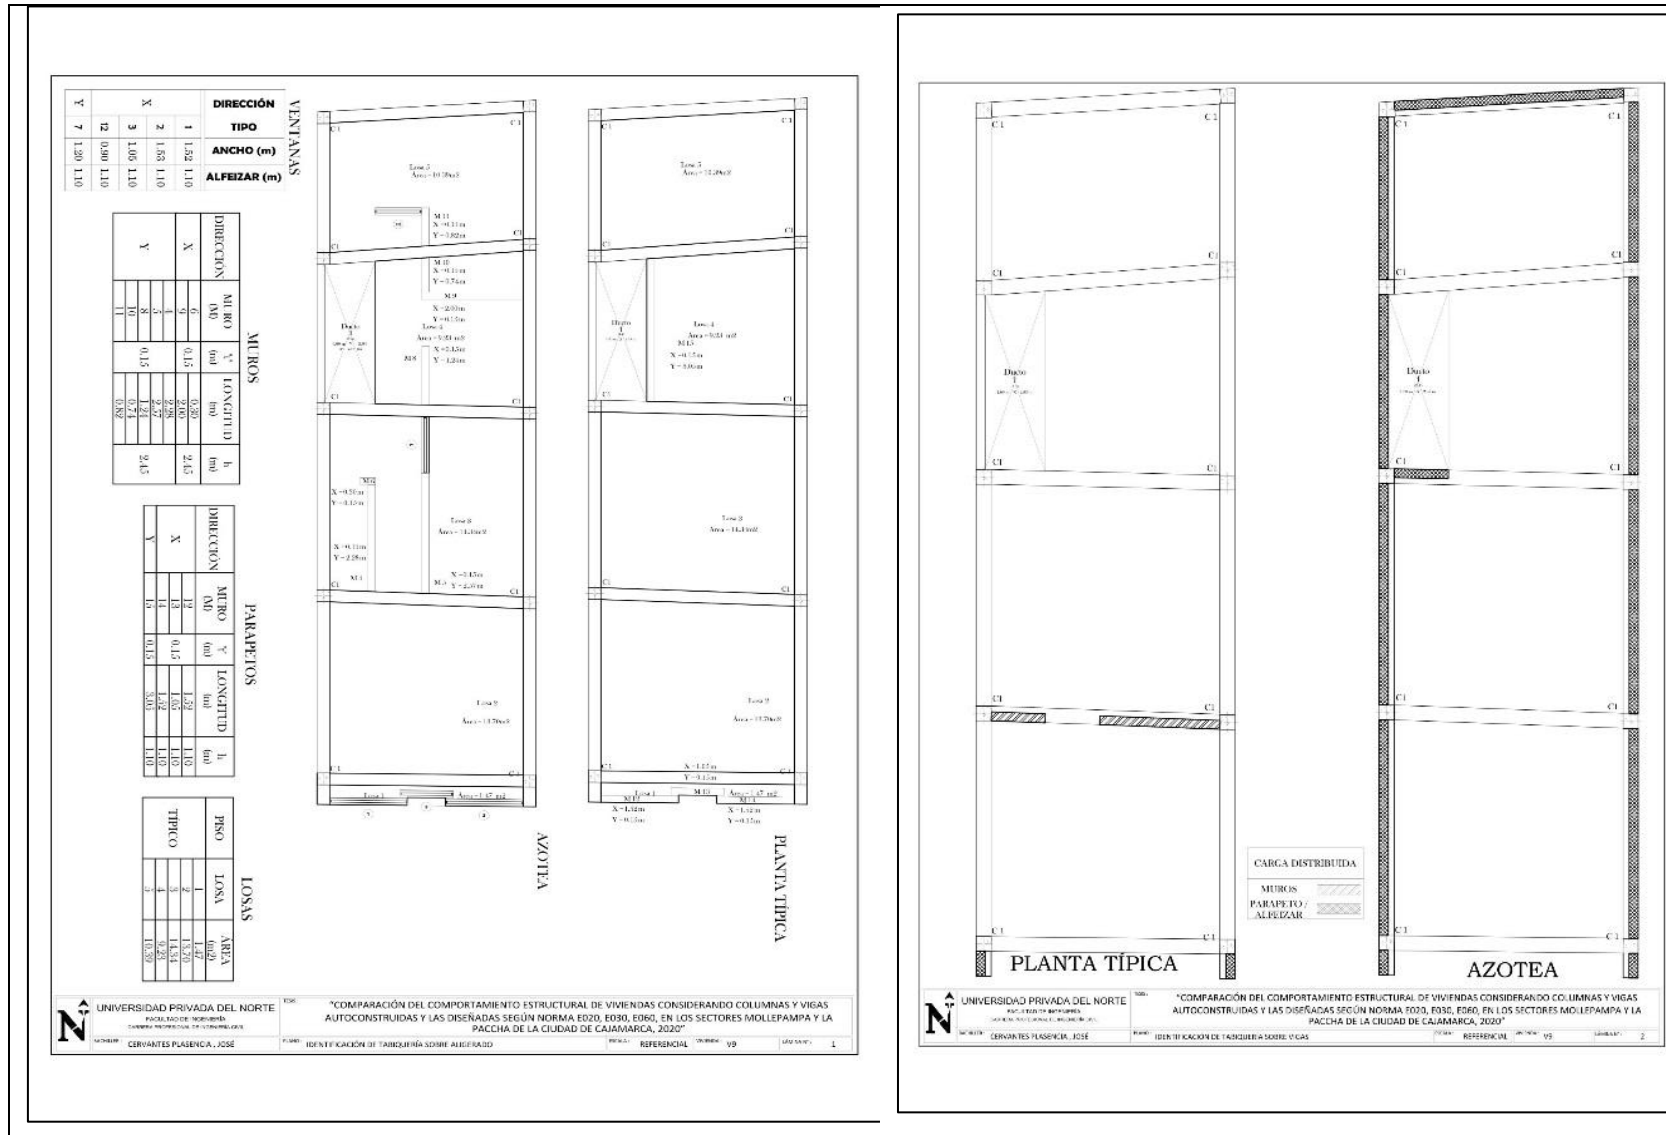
Tabiquería sobre losa aligerada y vigas vivienda 9
